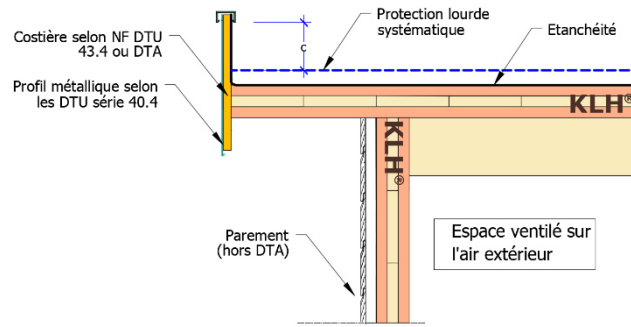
Toitures chaudes isolées en toitures terrasses accessibles
